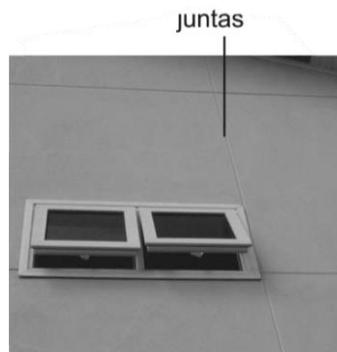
Fachada en OSB revestida con revoque y juntas a la vista para controlar la orientación de las grietas.
